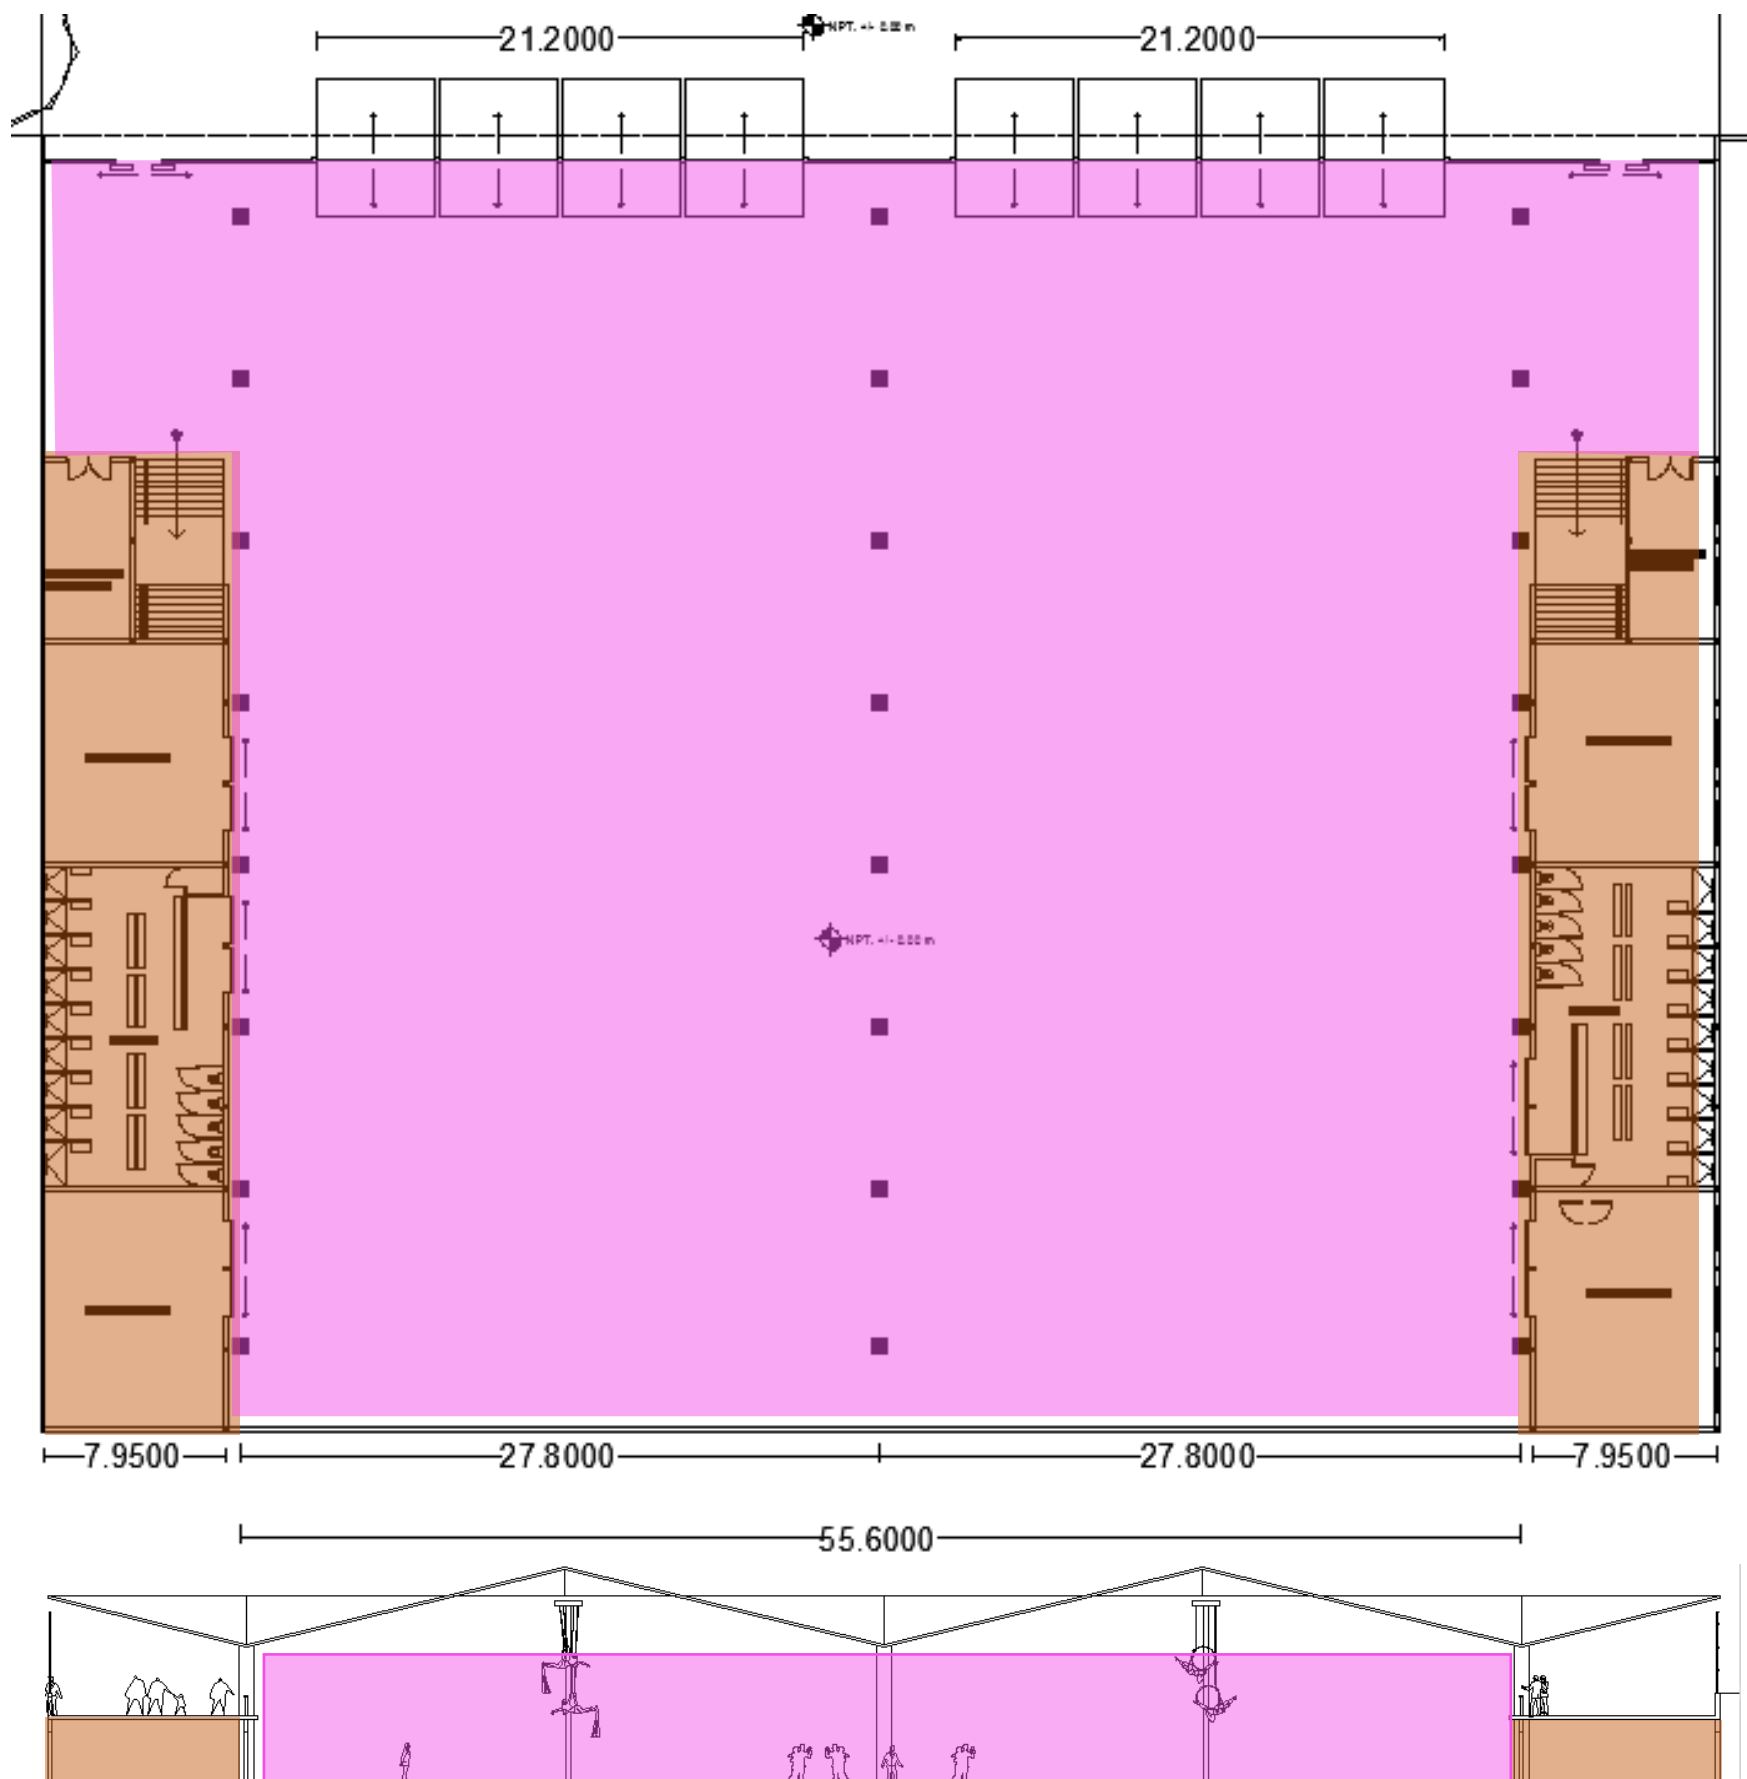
Planta de la zona de talleres Polo Cultural Bacardí
